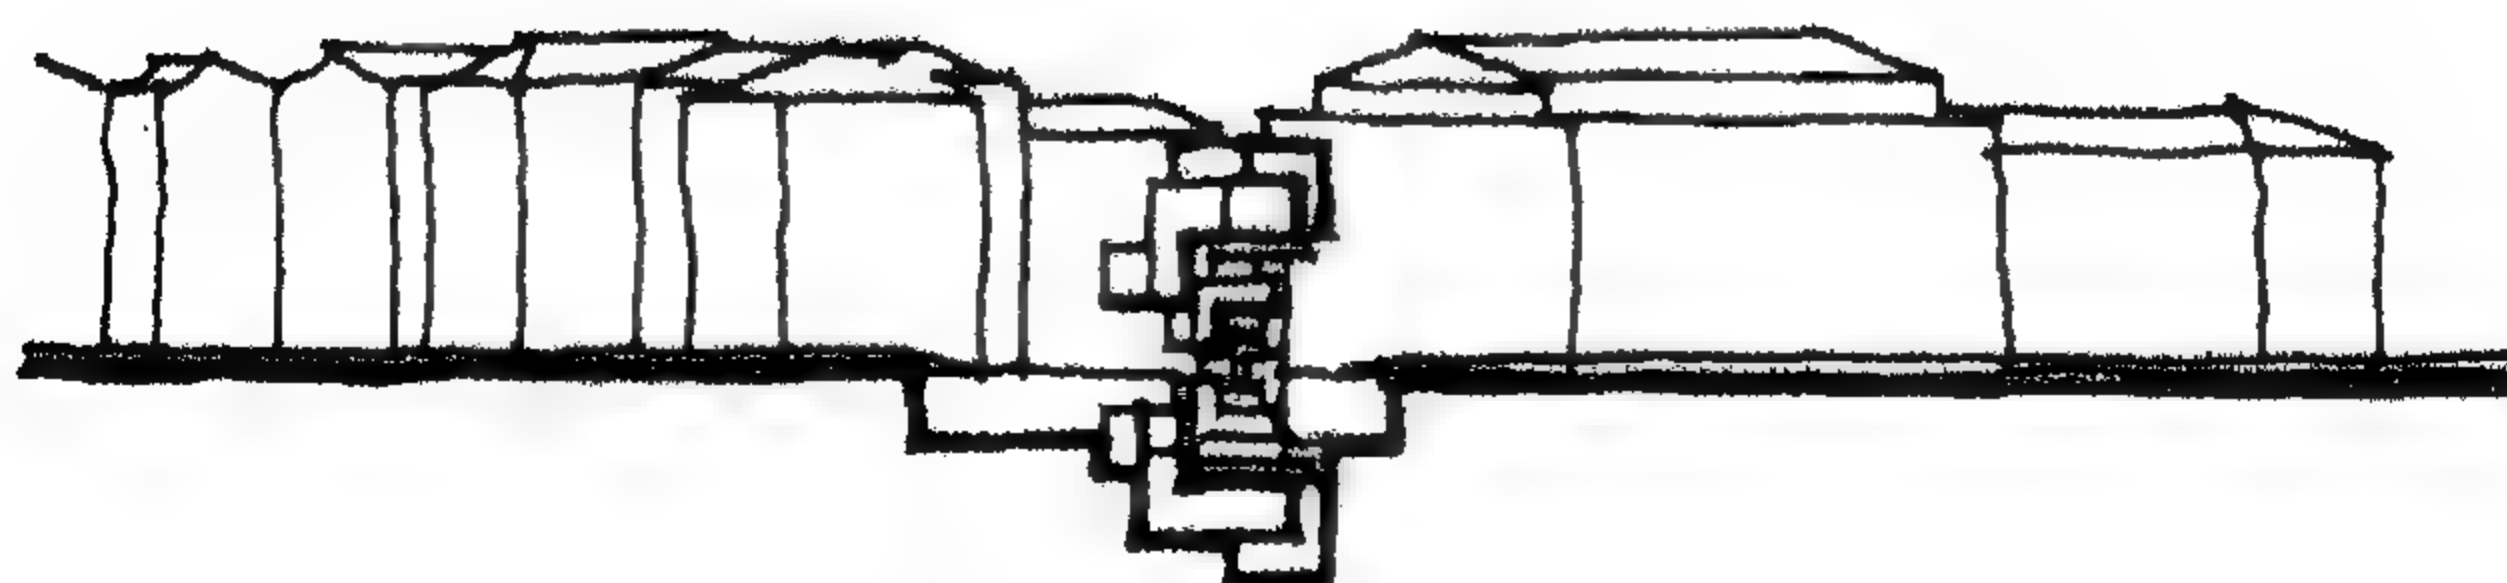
مسقط أفقي عام - ميدان كاناريجو - فينيسيا
